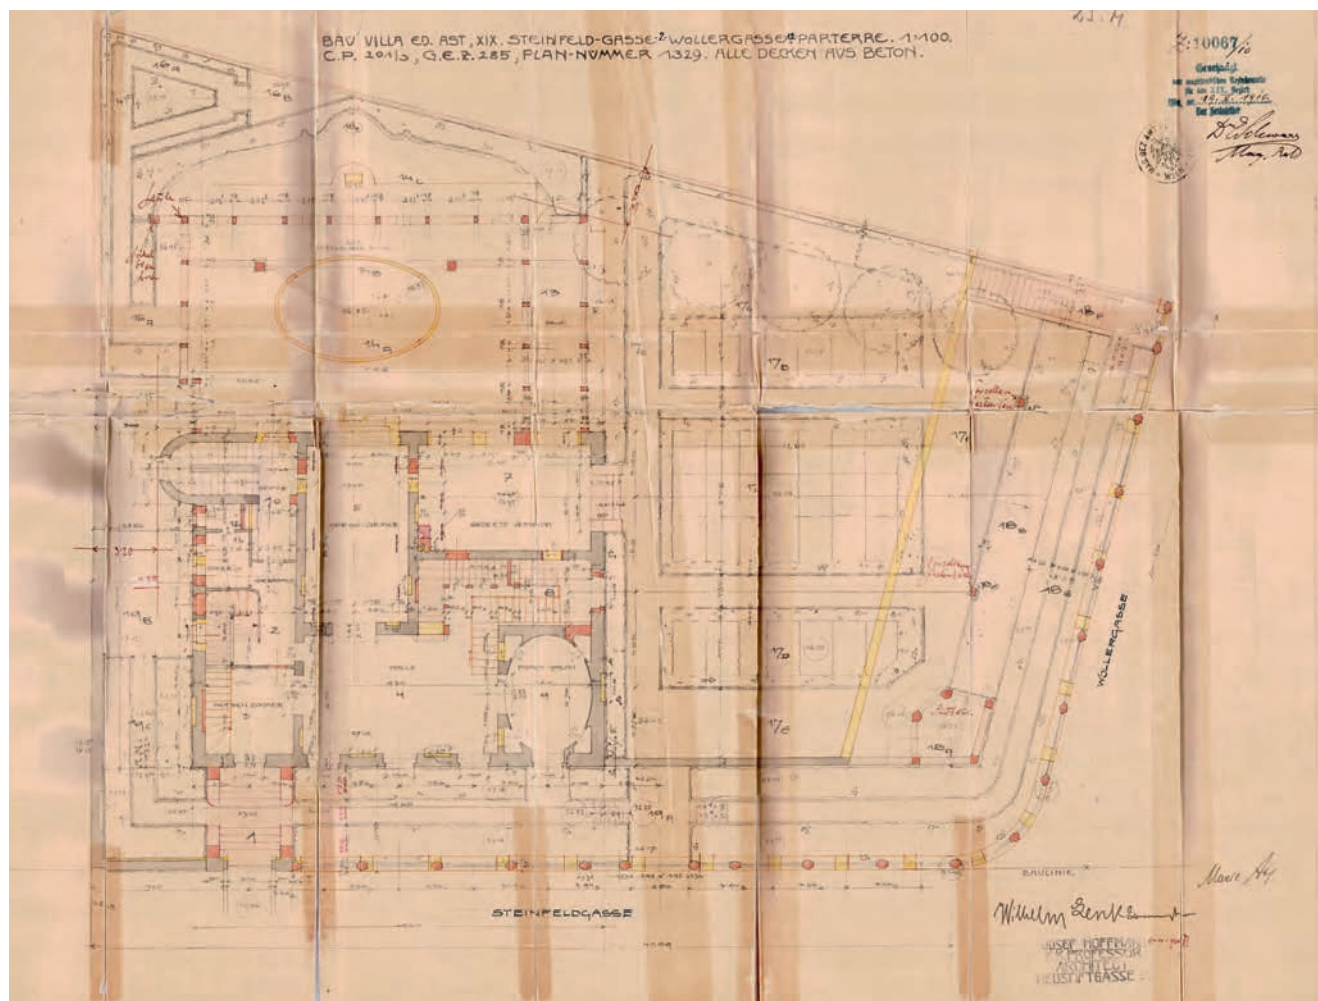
Villa Ast, Auswechslungsplan 1910, Grundriss der Hauptebebene
